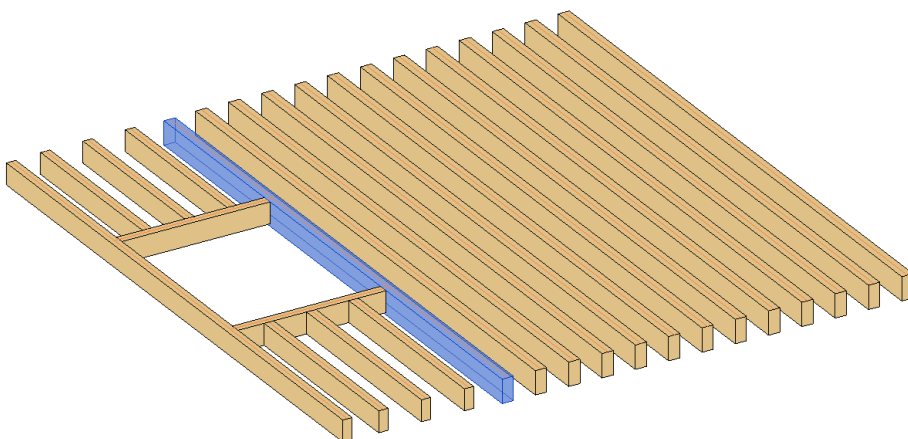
Modelação em Revit do novo pavimento (vigamento) da divisão Norte, lado nascente. Viga V4.
